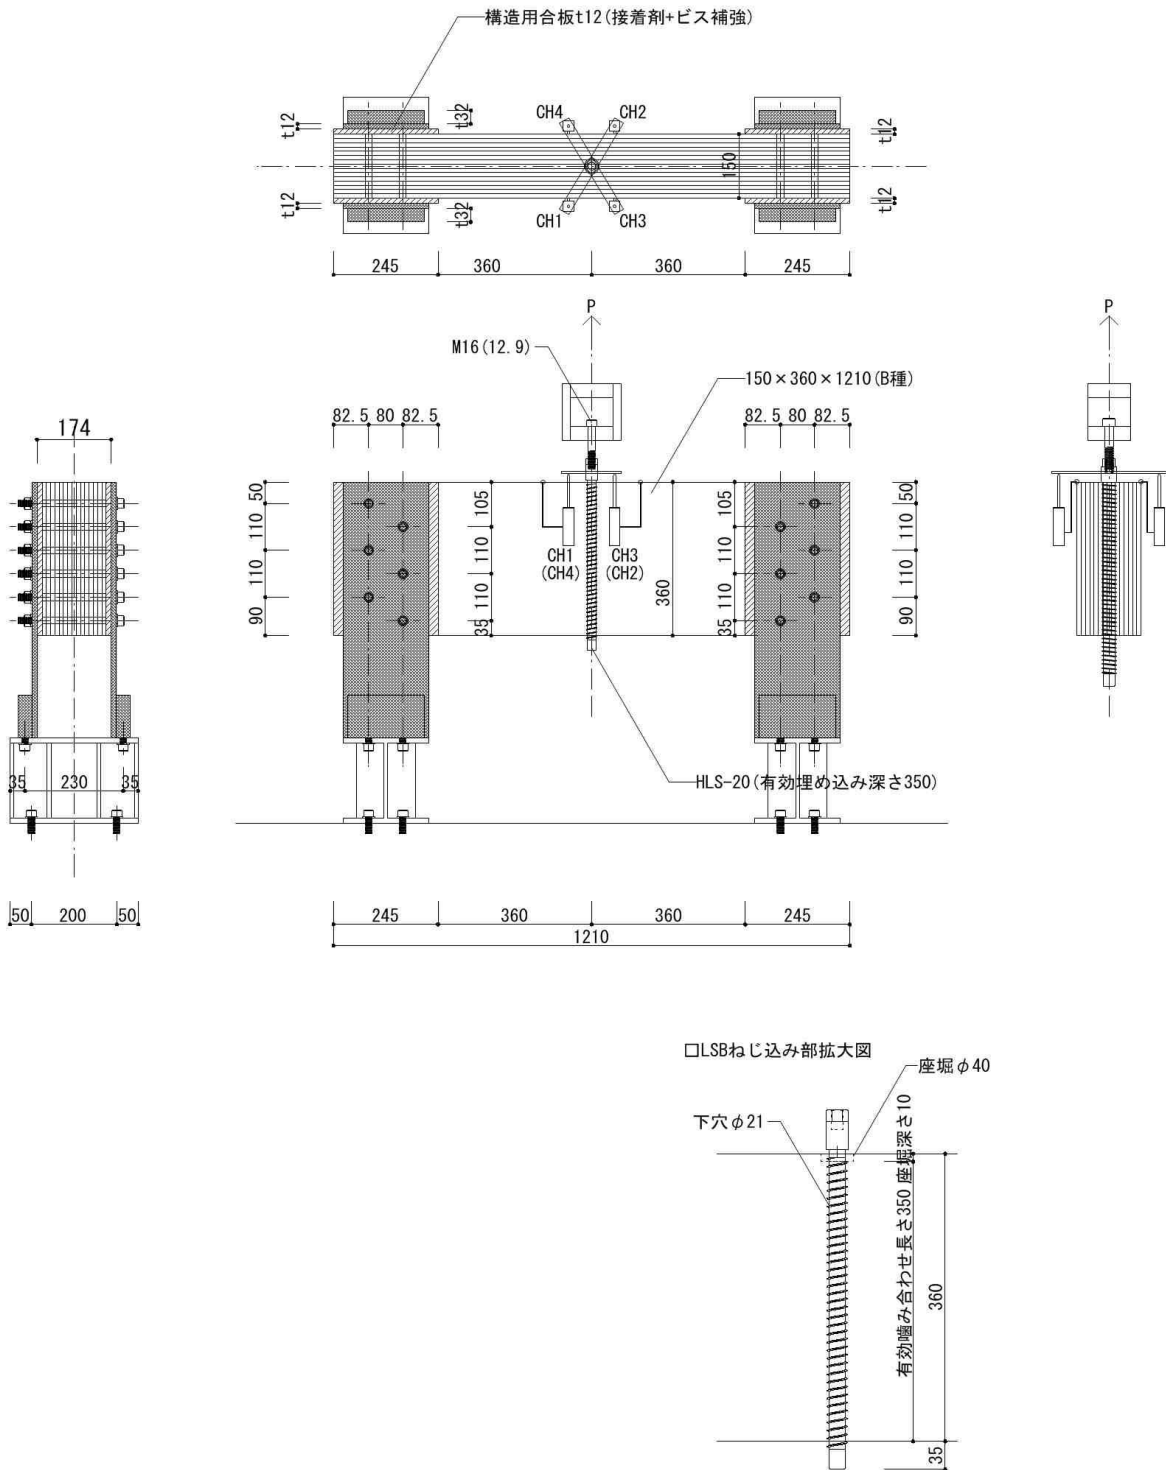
試験体の形状及び寸法 (B-4)
